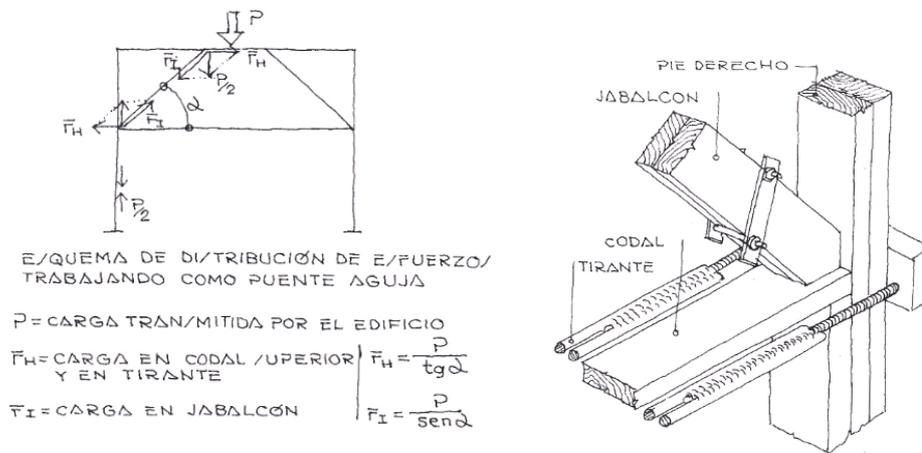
Esquema de carga y detalle de nudo de unión en puente de apeo con jabalcones y tirante.
